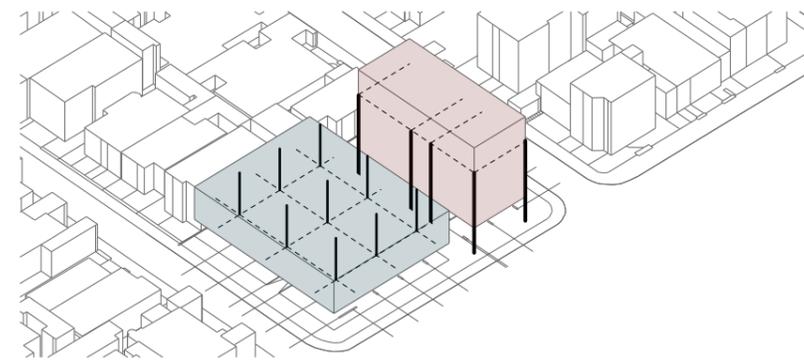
Estructura que contiene elementos y elemento que contienen la estructura.
